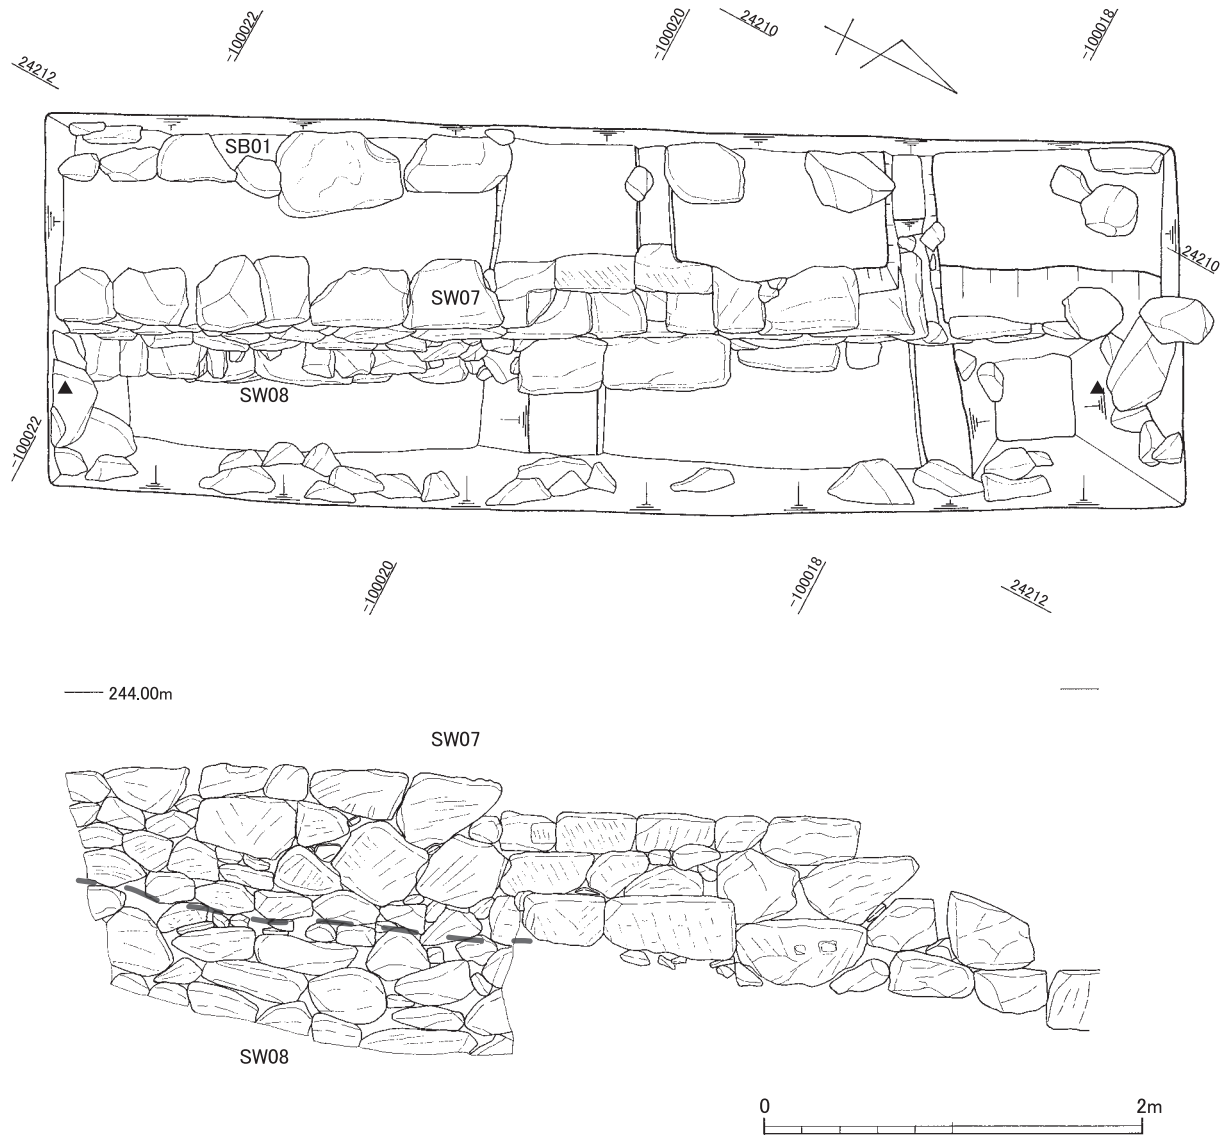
昆布山谷地区第5地点第1トレンチ平面図・立面図 (1/40)
